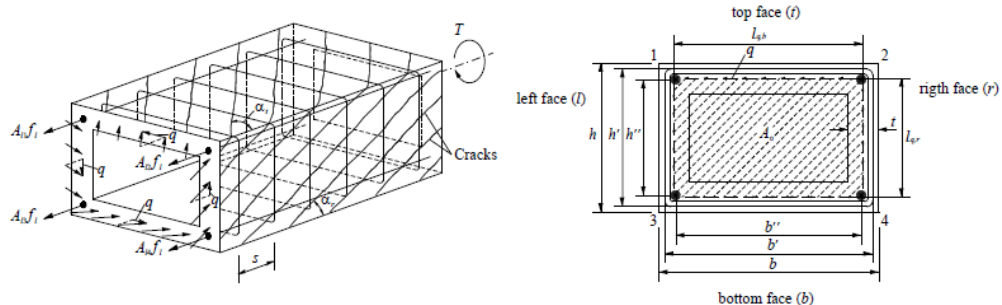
Viga de secção retangular oca sujeita a torção pura [25].
